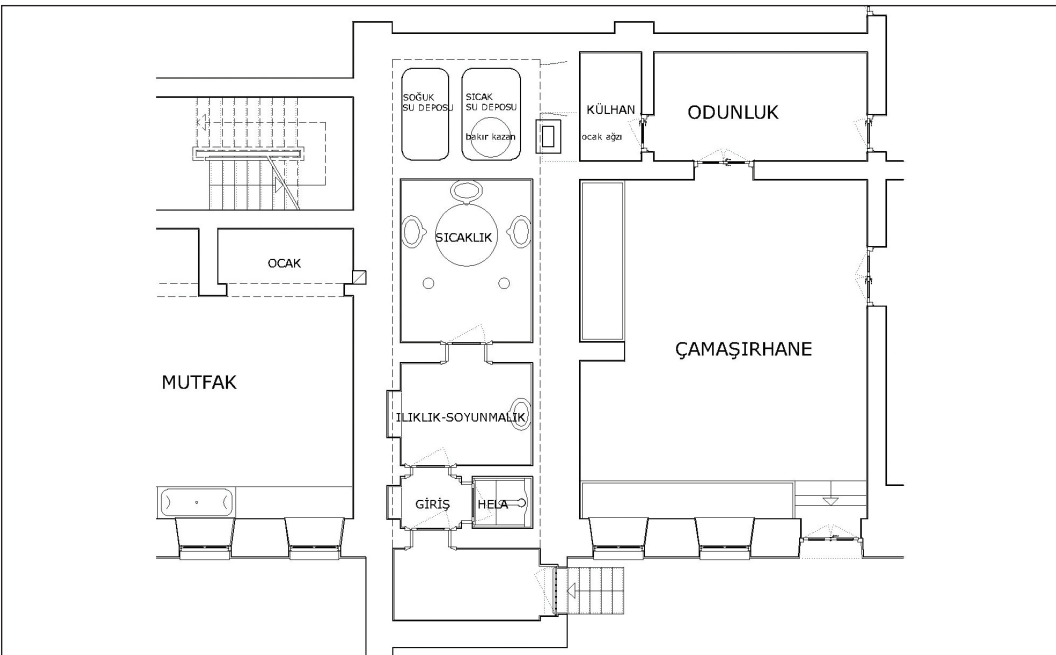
Ethem Paşa Konağı bodrum kat tavan planı
